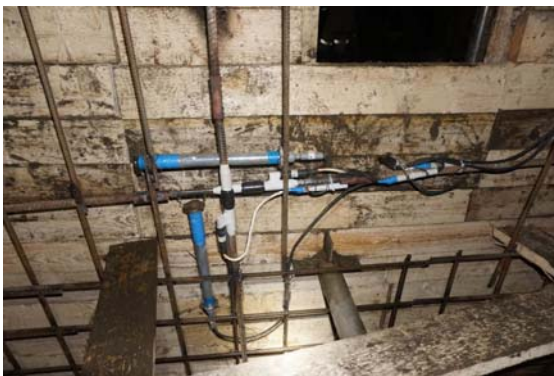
Схема расположения струнных деформометров перед бетонированием железобетонной ограждающей конструкции
